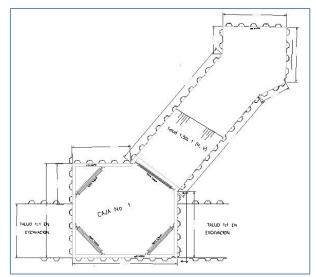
Planta de Construcción de la caja C-1 y su correspondiente Talud.
